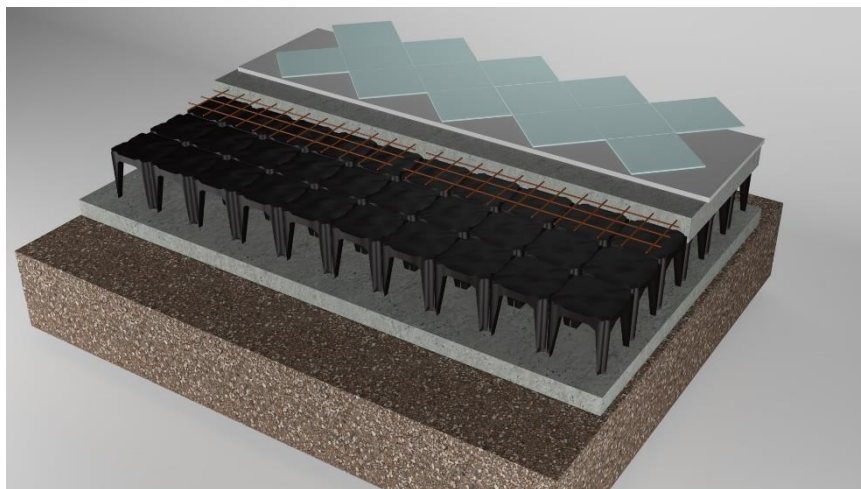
Losa ventilada, sistema caviti. 2015. Fuente propia.
